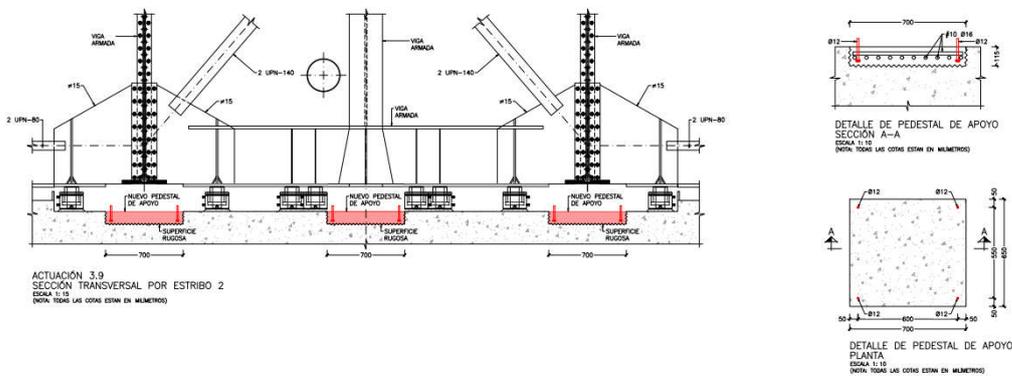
Colocación de armadura y anclajes en pedestal de apoyo
